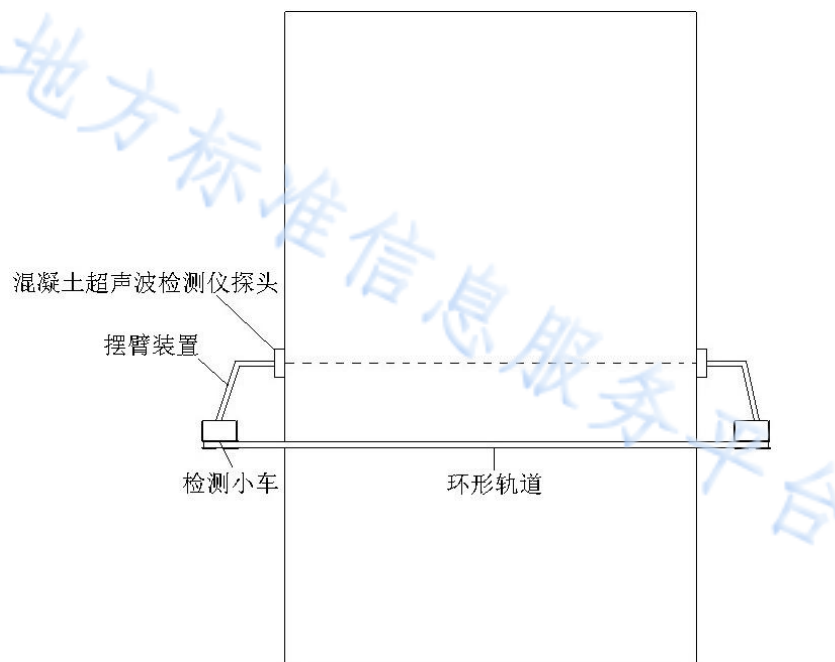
爬行装置检测混凝土内部缺陷（不密实区）示意图
